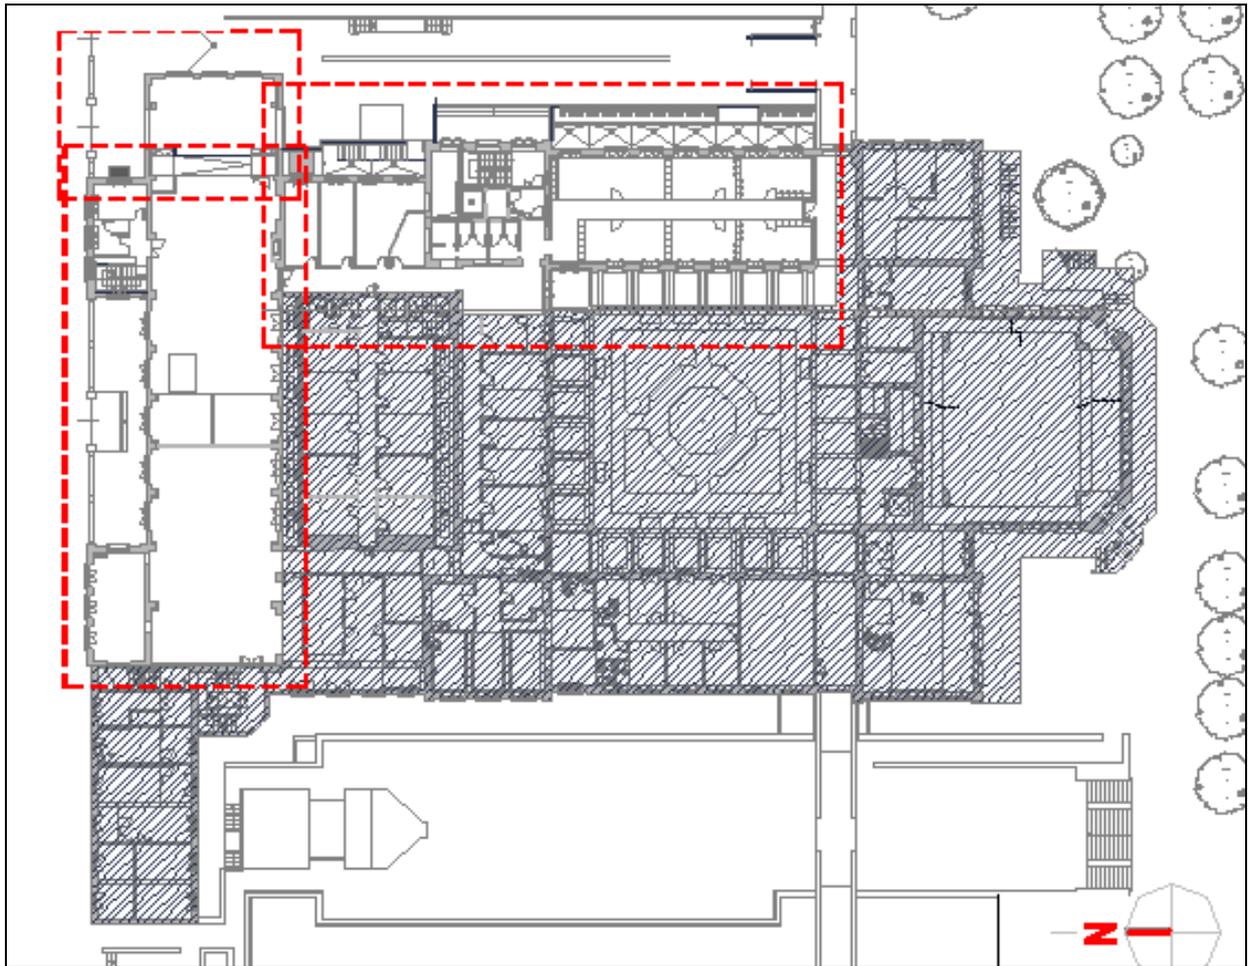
Planimetria generale (PT) dell'edificio 4 con identificazione delle zone di intervento.
